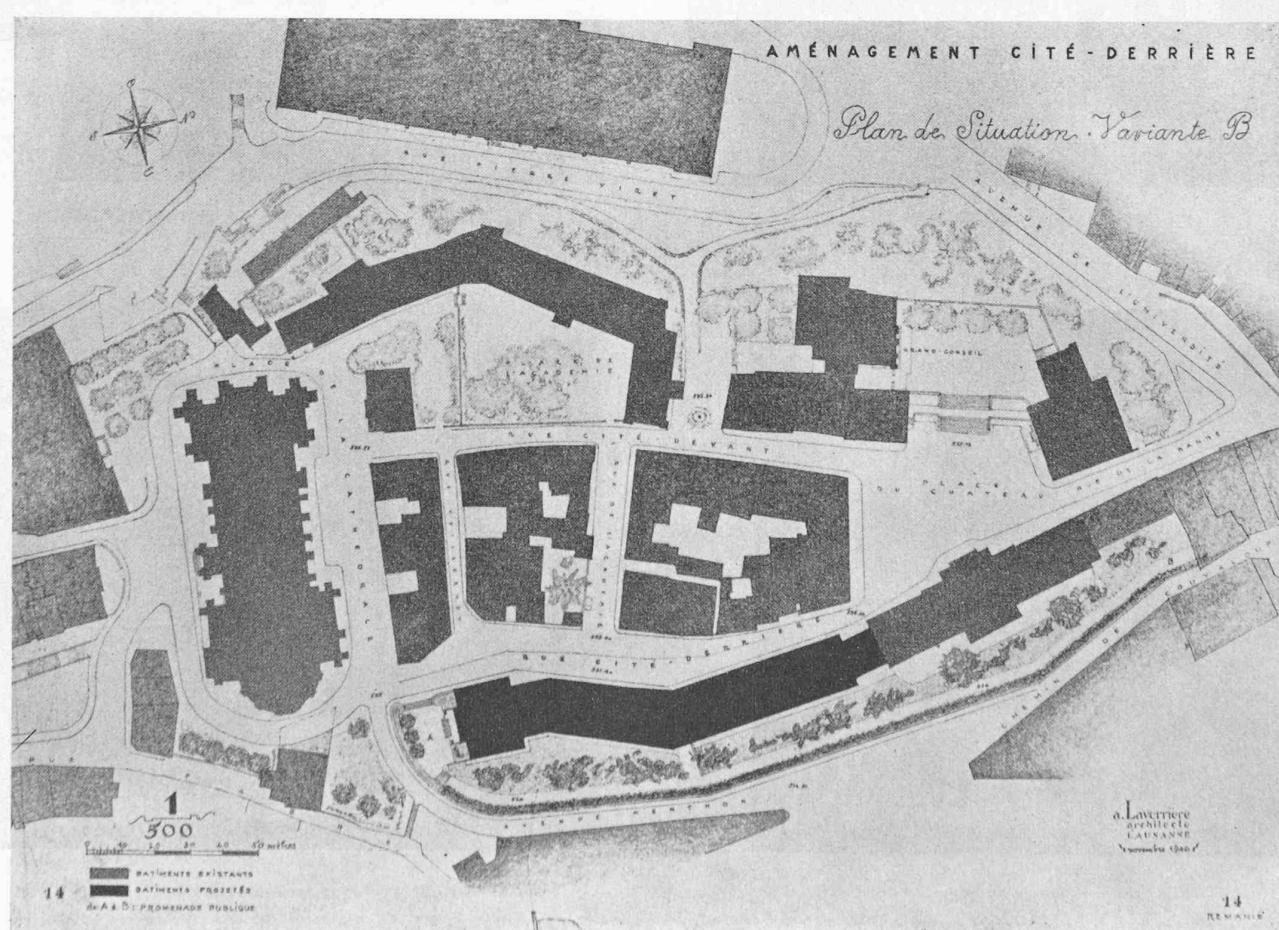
Plan de la Cité. En noir : le bâtiment projeté.
